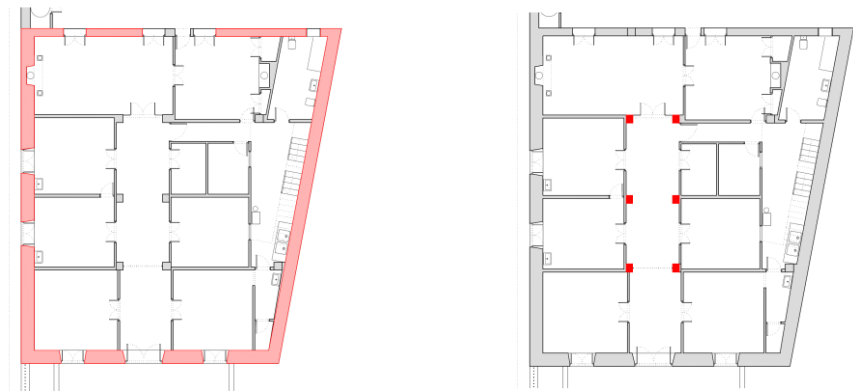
Esquema de situación del muro de carga perimetral y los 6 pilares centrales de ladrillo. 2023. Fuente: propia.
